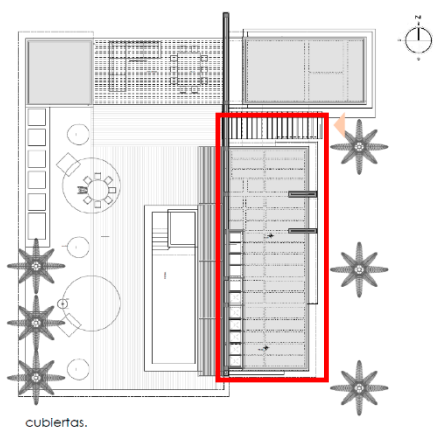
Planta zonificación en donde se instalará la cubierta verde
